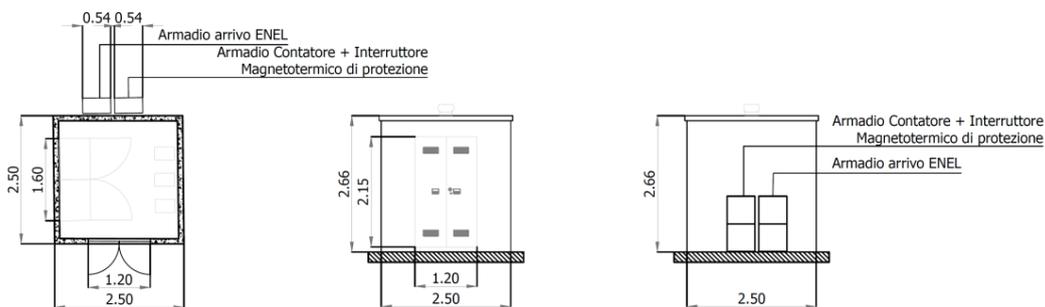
Cabina elettrica - Prospetti anteriore e posteriore
